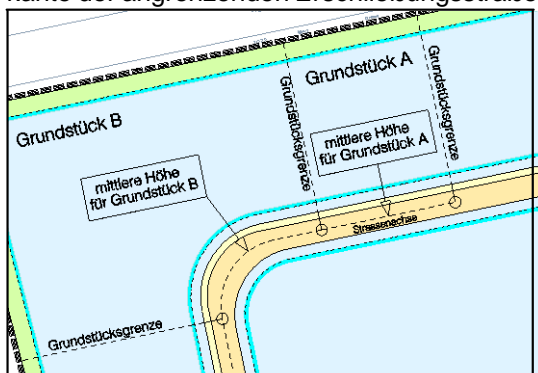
Schema zur Ermittlung des Bezugspunktes
